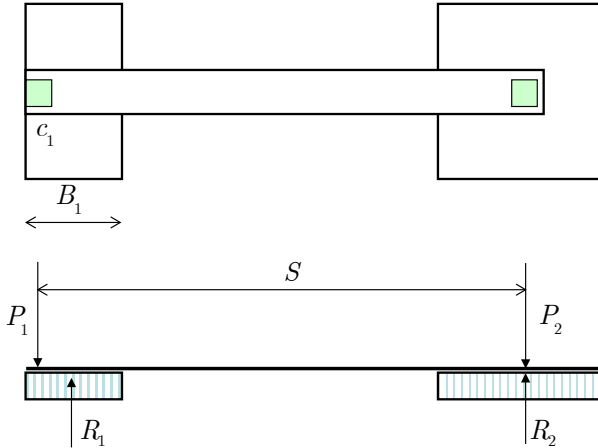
Zapata excéntrica con viga de vinculación – Planta y esquema estático
